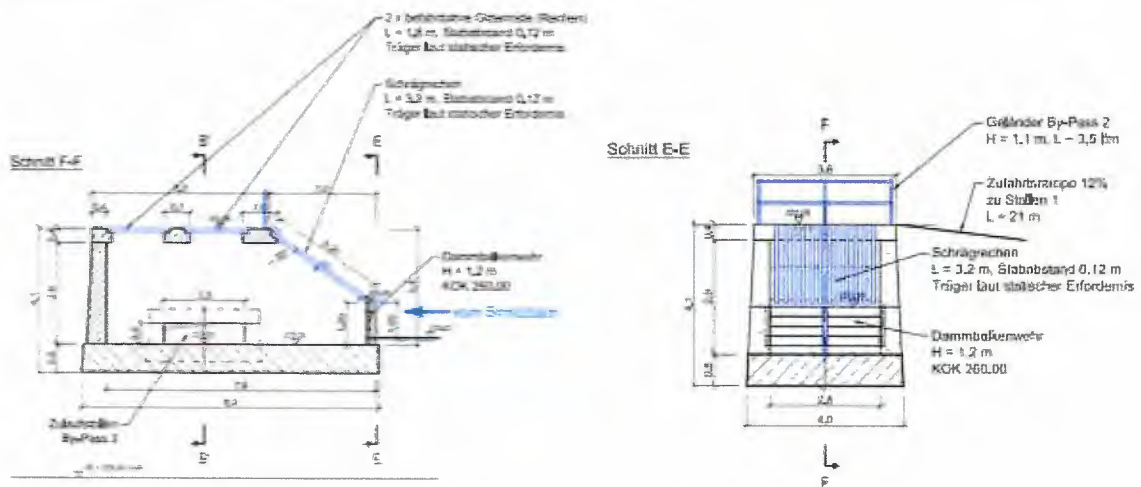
Einlaufbauwerk Bypass 2; aus Plan 12.5.7
